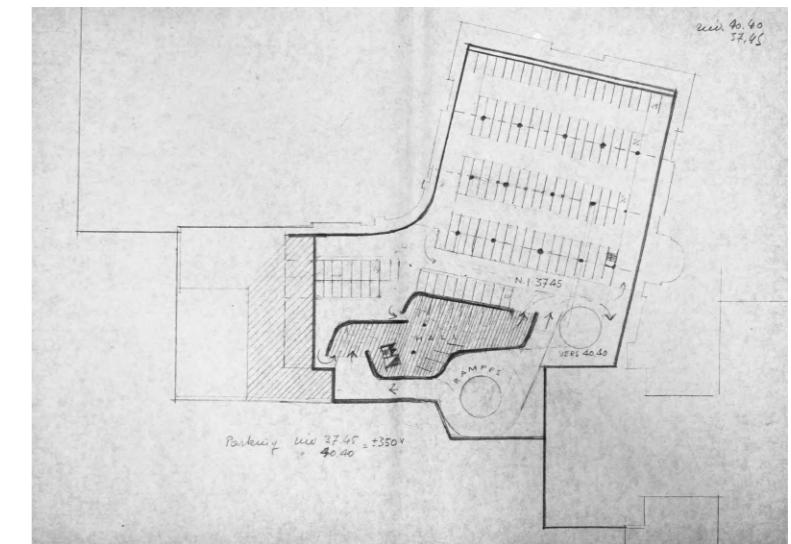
Plan d'un niveau de parking, 7^{ème} esquisse.
